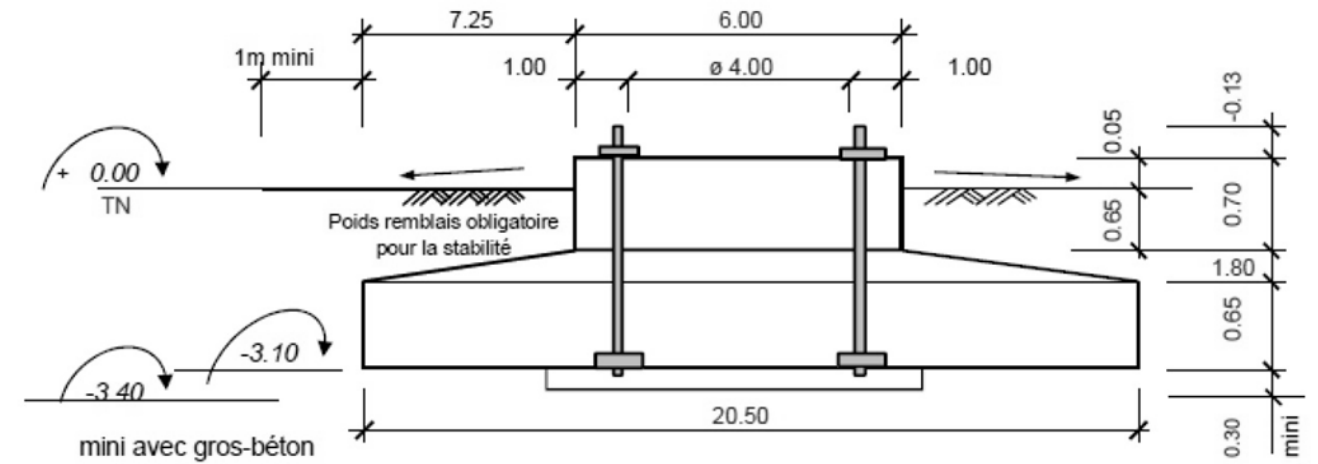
Exemple de fondation d'éolienne vue en coupe (Source : VESTAS)
